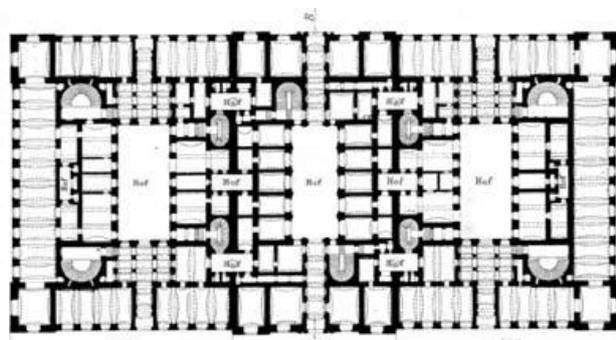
Grundriss Heinrichhof, 1861
